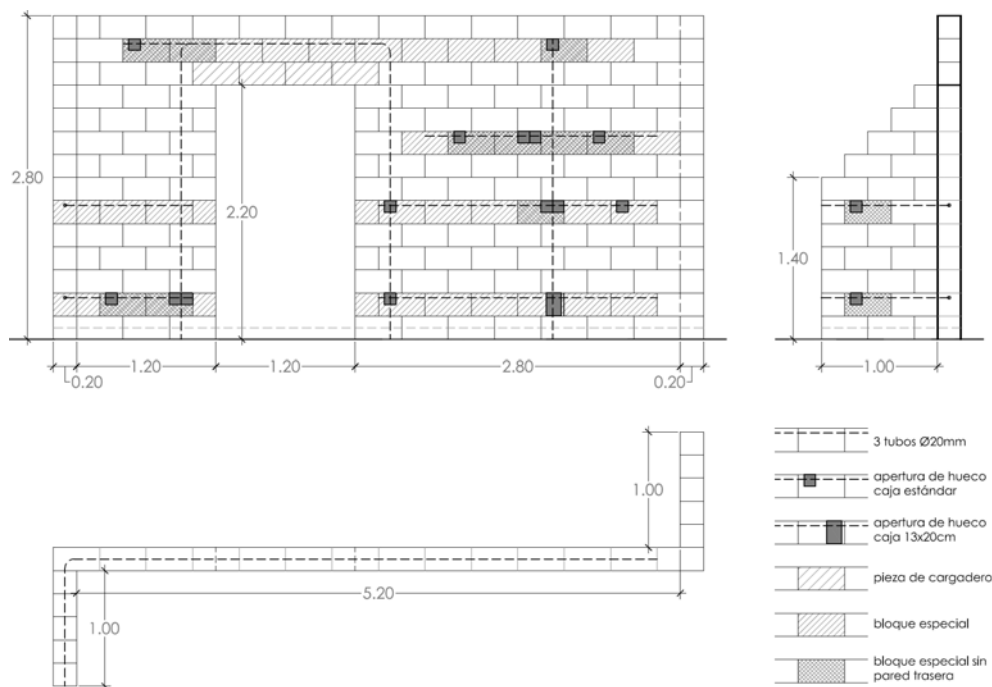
Muro proyectado para la realización de las pruebas de puesta en obra del nuevo bloque, y del tendido de la instalación eléctrica.
